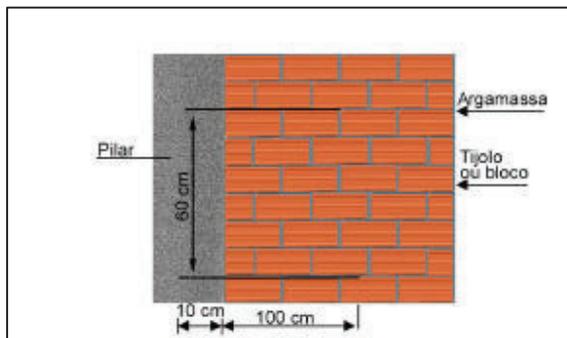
Amarrações das Fiadas e Canto de Parede fig 13
